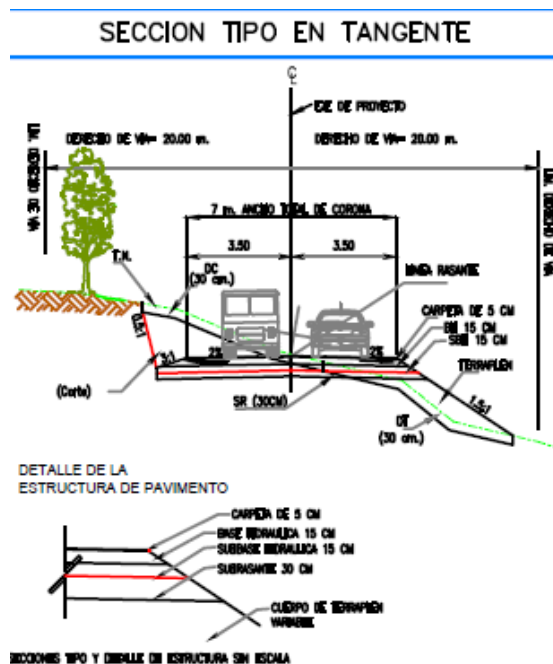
Sección tipo del perfil de una carretera tipo D
